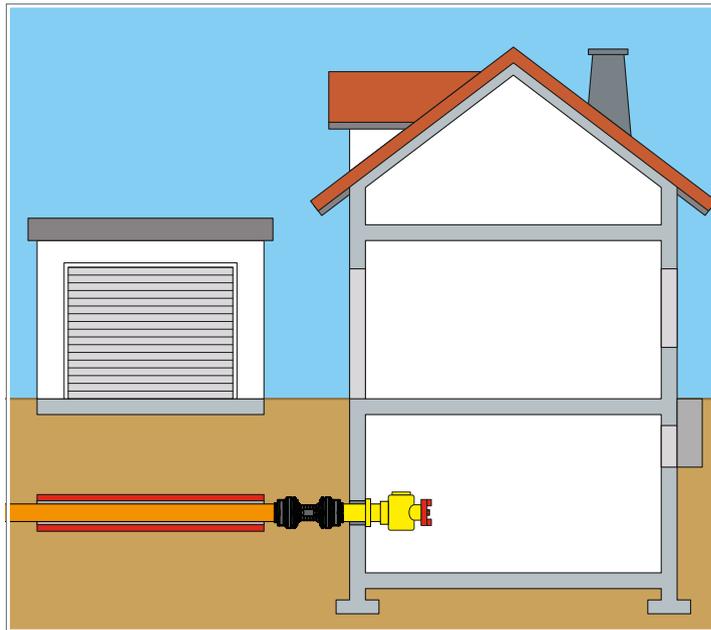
Rohrleitungsführung unterhalb von Bebauungen
